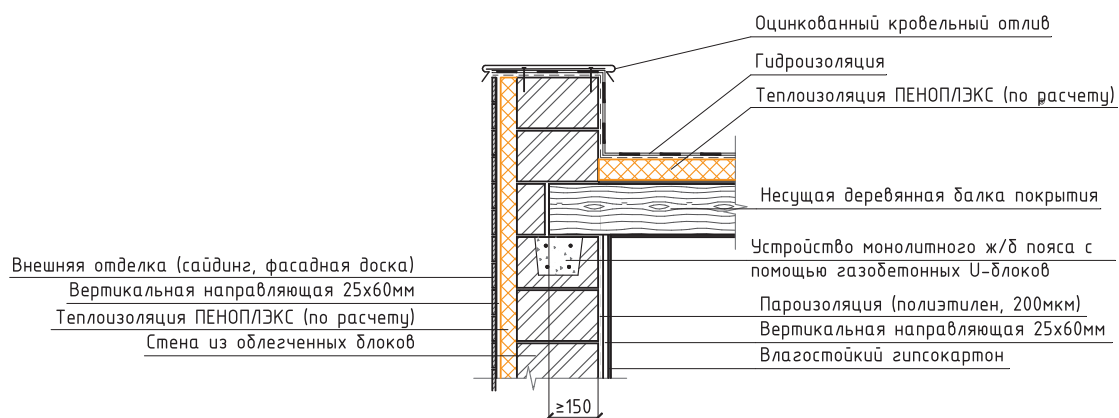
Схема примыкания теплоизолированной стены из облегченных блоков к конструкции плоской кровли.
